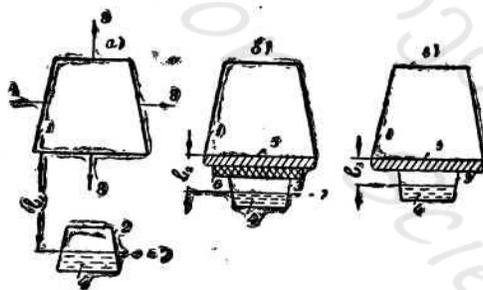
Схемы основных вариантов водоотвода: а — специальной выработкой; б — каналом с теплоизоляционным перекрытием; в — каналом с простым перекрытием; 1 — горячая выработка со свежим воздушным потоком; 2 — специальная водоотводящая выработка; 3 — водоотводящий канал; 4 — горячая вода; 5 — несущее железобетонное перекрытие; б — теплоизоляционное перекрытие; 7 — условный уровень термальных вод; 8 — основные направления, вдоль которых строится распределение температуры в массиве
